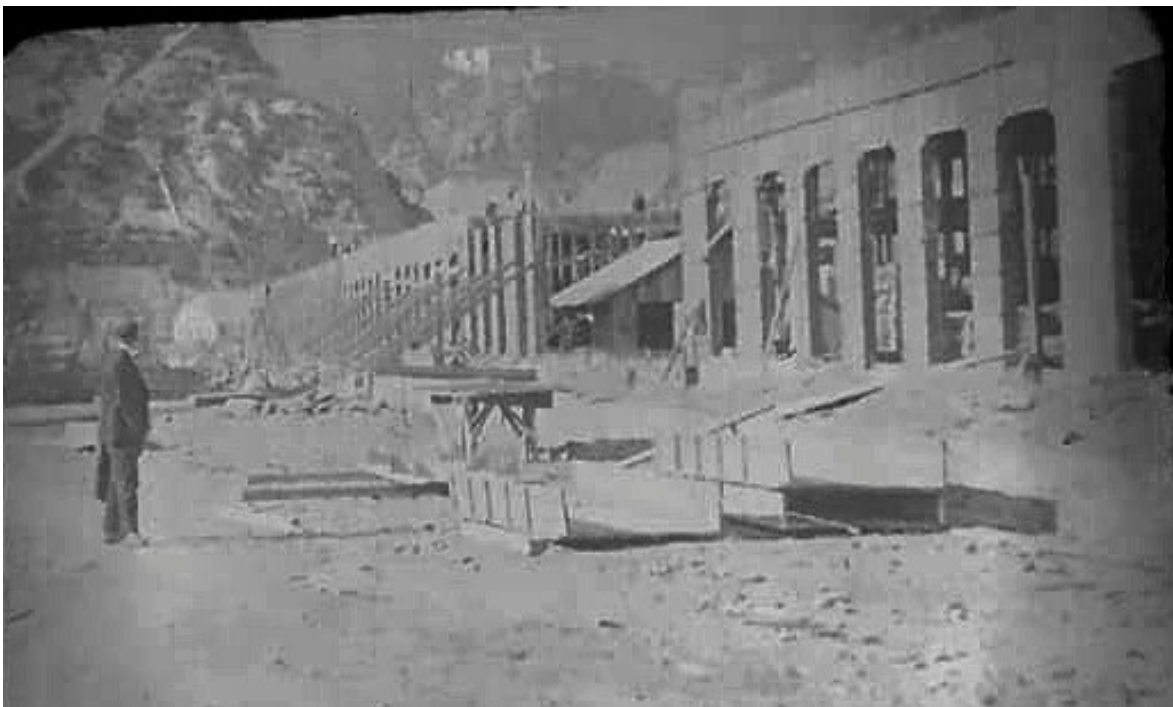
Primera planta del Edificio de Servicio. En el suelo se pueden observar los moldes de madera para el encofrado con hormigón en masa. Foto: Filmoteca Española, c. verano 1922.
